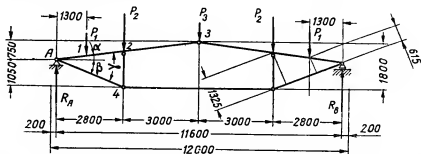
Геометрическая и расчетная схемы шпренгельной фермы и схема нагрузок.
